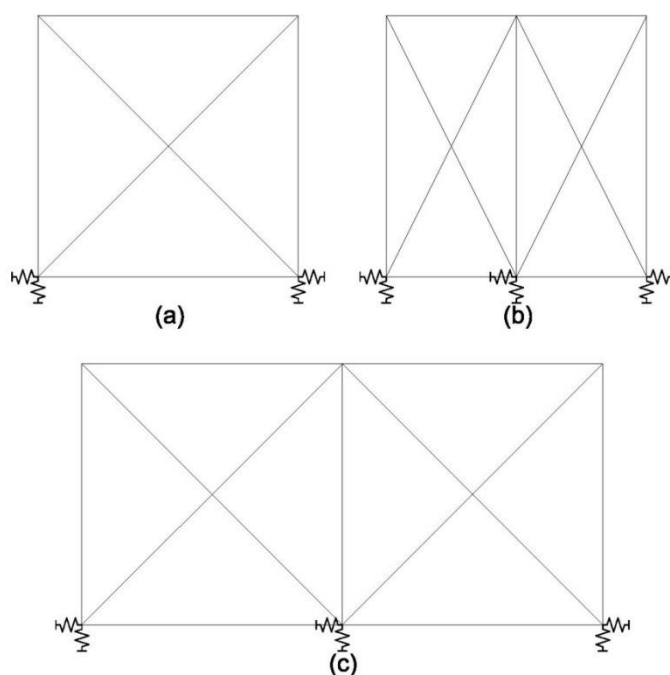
Schematizzazione in OpenSees delle Wall A (a), Wall B (b) e Wall C (c)
